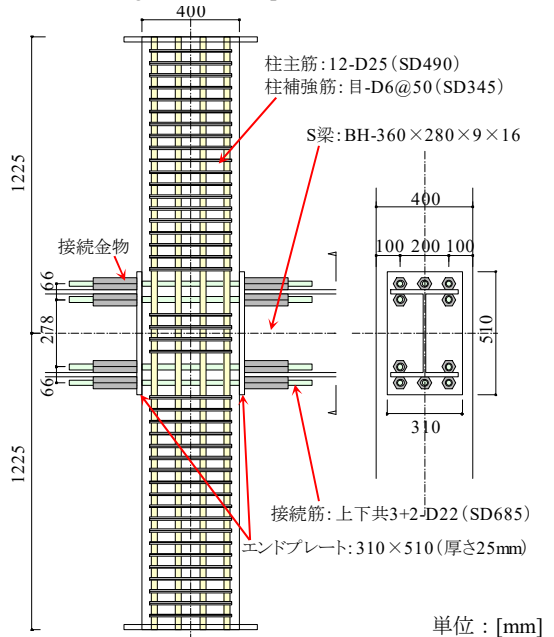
基準試験体(No. 2)の配筋図(立面図)
